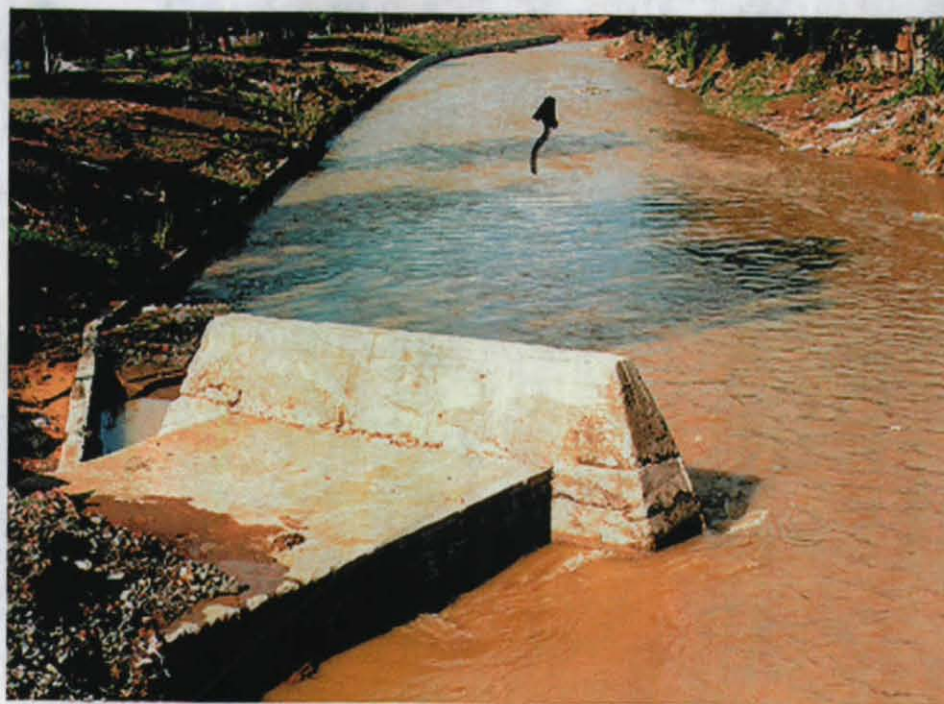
Y 23.- Canal Vipasa- La Campiña en la calle 45, vista general hacia aguas arriba, y vista del box culvert de la Av. 2ª hacia aguas arriba.
